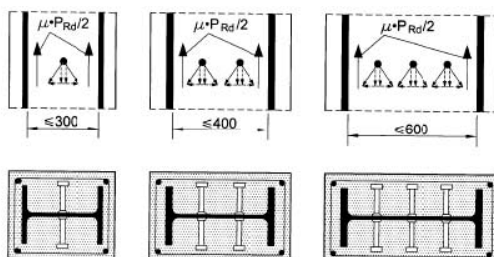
Disposizione dei pioli per la connessione meccanica acciaio-calcestruzzo
